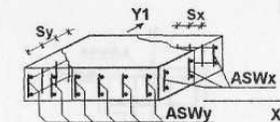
Армирование элементов железобетонной плиты и оболочки
